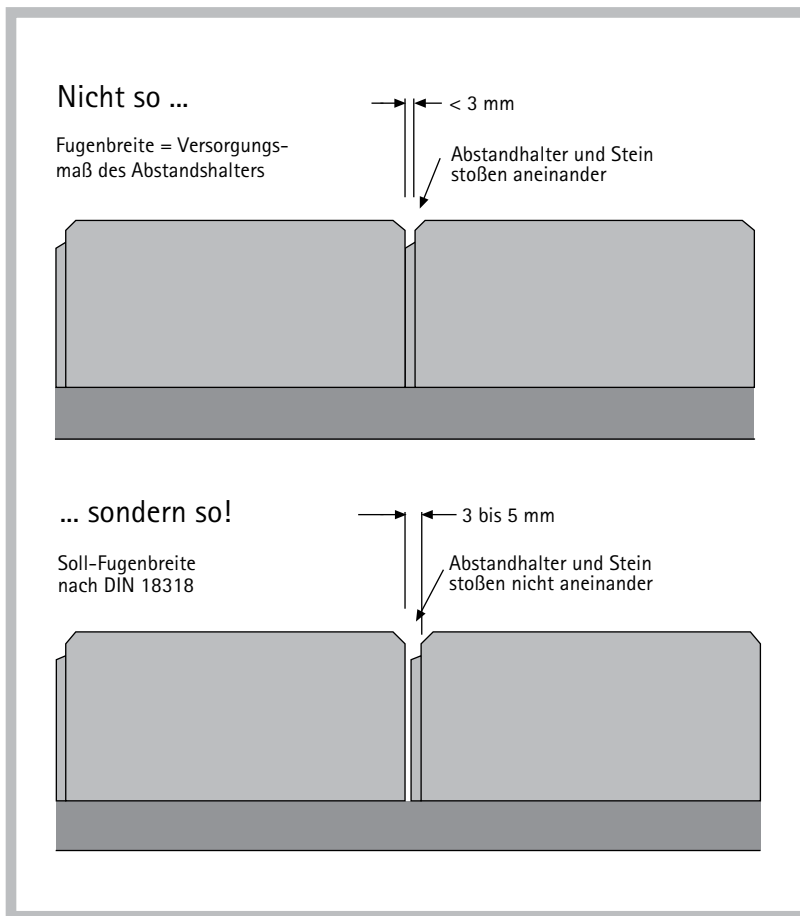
Fachgerechte Fugenausbildung bei Betonpflastersteinen mit Abstandhaltern
